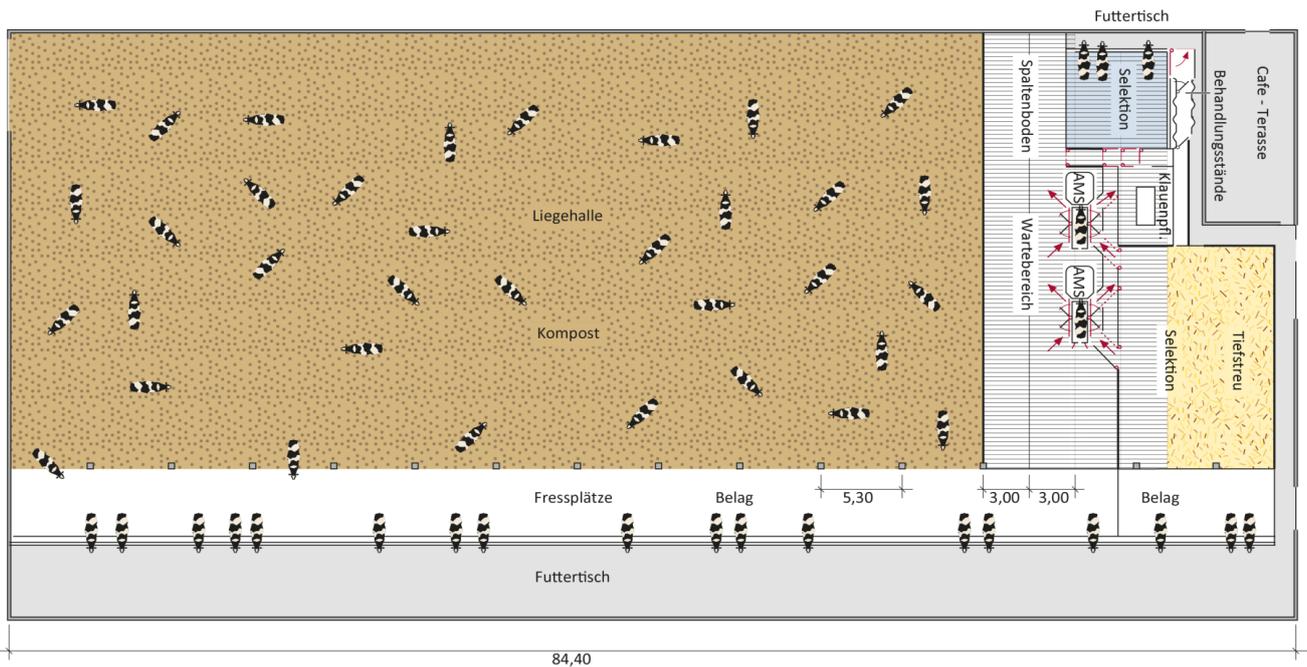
Grundriss - Betrieb Holstein Bachschweller GmbH
